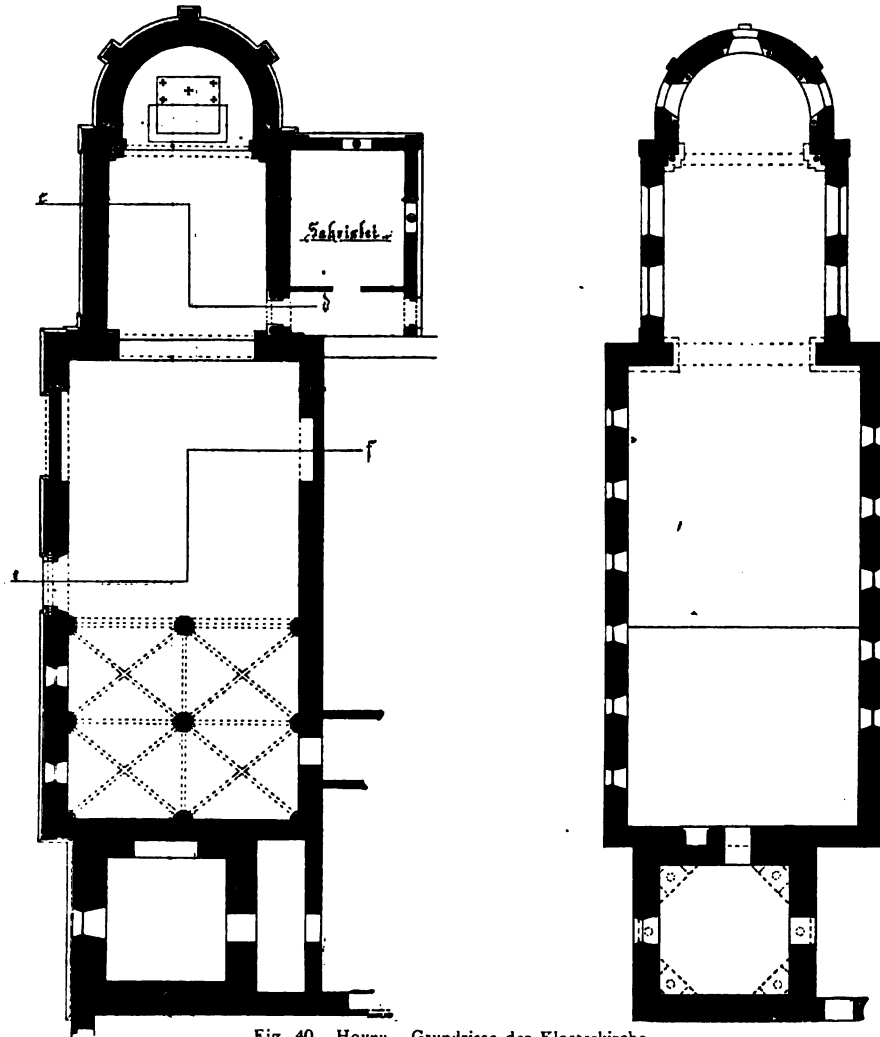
Hoven. Grundrisse der Klosterkirche.
